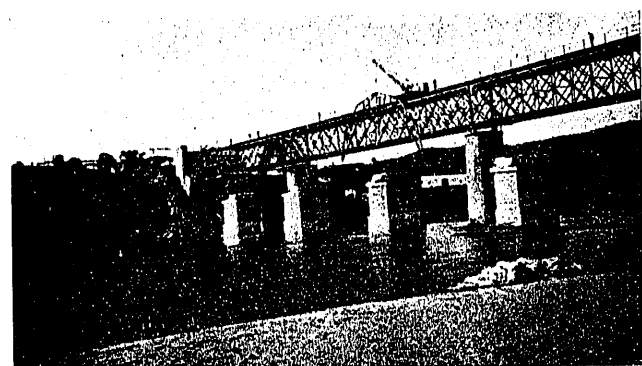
A la izquierda, estribo de entrada del puente actual. A la derecha, bloque del nuevo estribo, inclinado un 5 por 100 hacia fuera.
